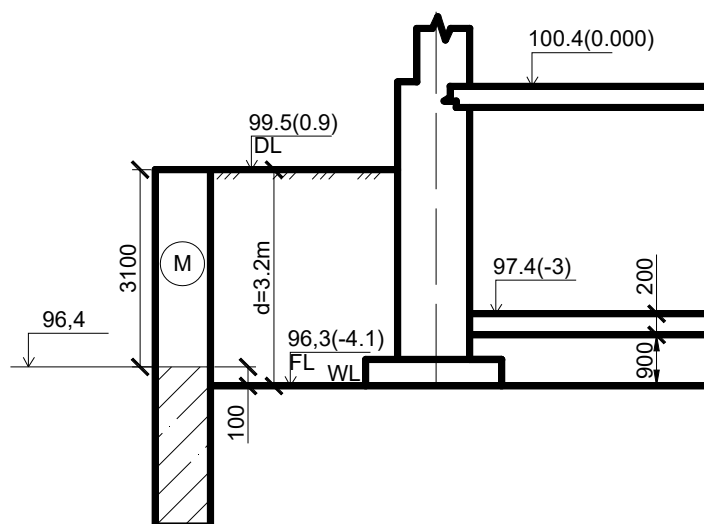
Определение глубины заложения фундамента к примеру 4
